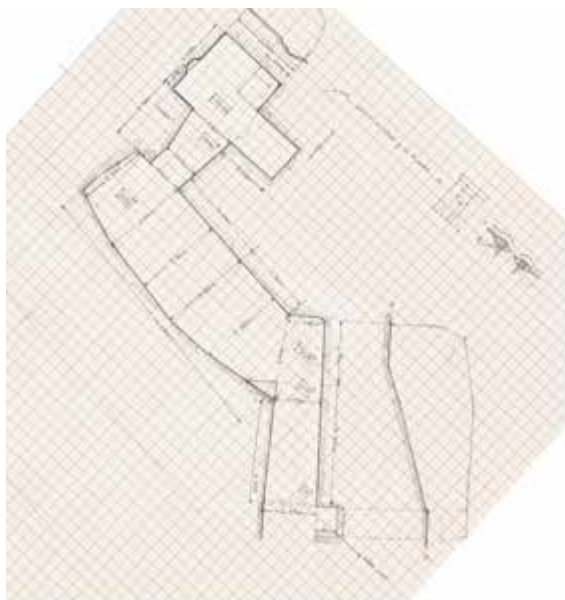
Reconstrucciones en planta y sección de las tumbas localizadas en el sector este (TT316 y MMA519).
